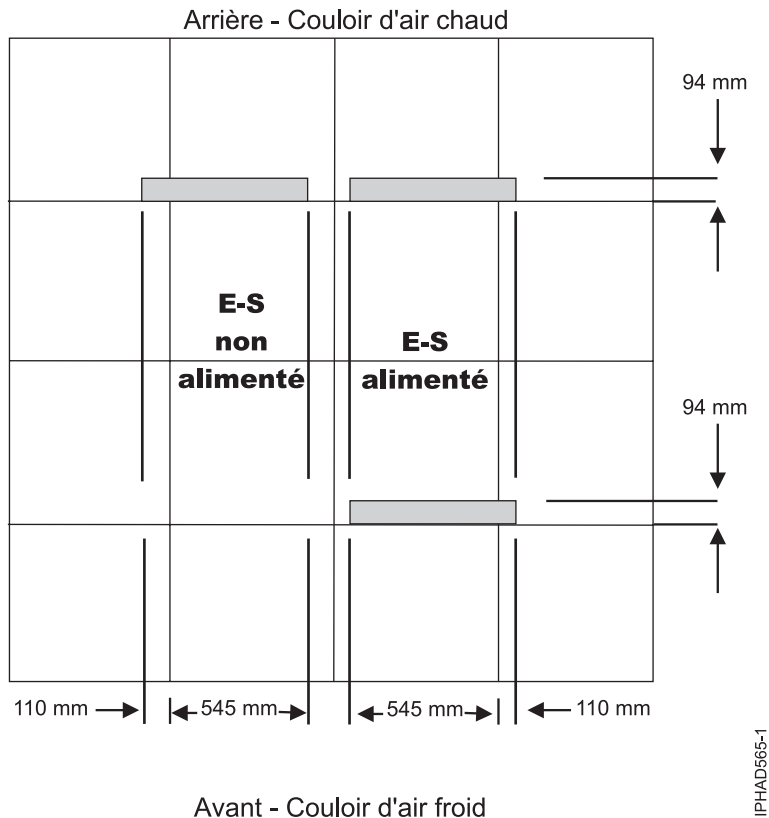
Positionnement des coupes de câble pour dalles de plancher de 610 mm
